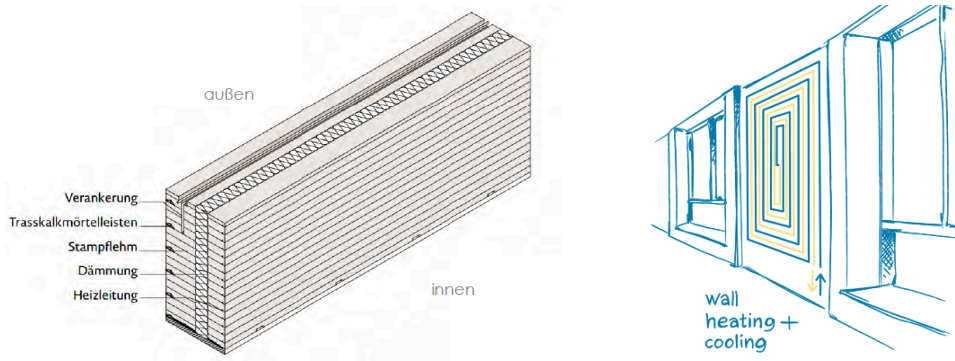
Axonometría, composición del muro prefabricado. Camus Alnatura.
